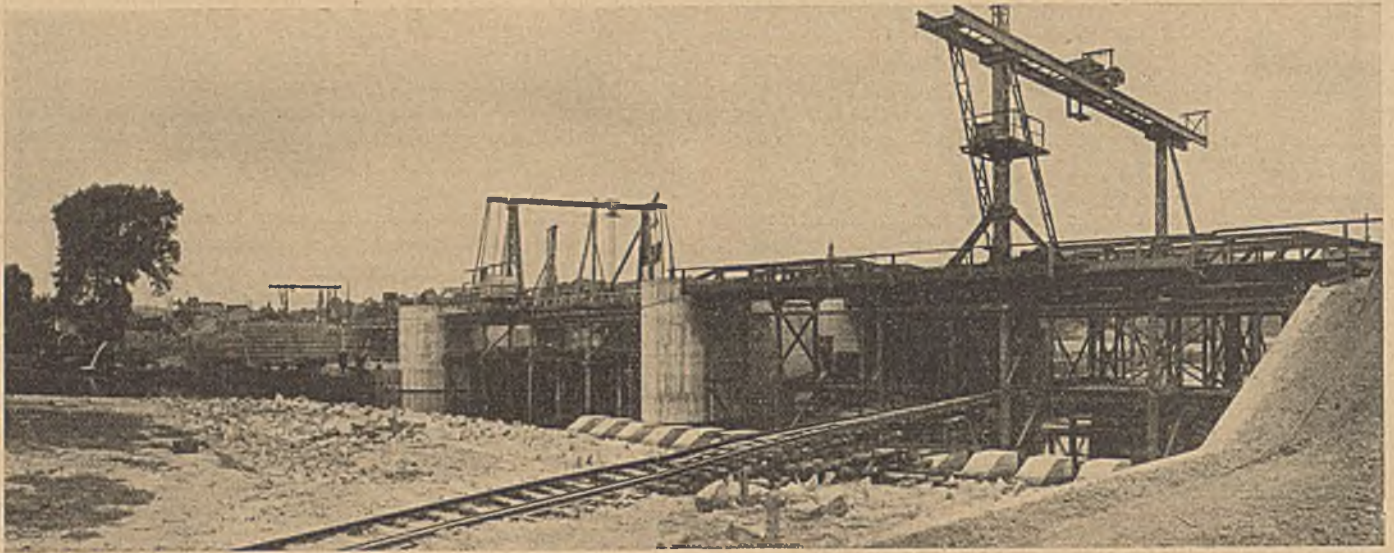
Wehrbaustelle. (Bauzustand Juli d. J.) Wehröffnungen III und IV für den Durchfluß freigegeben. Baugrube für die Wehröffnung I am rechten Ruhrufer umspundet. Betonieren des Endpfeilers I.
